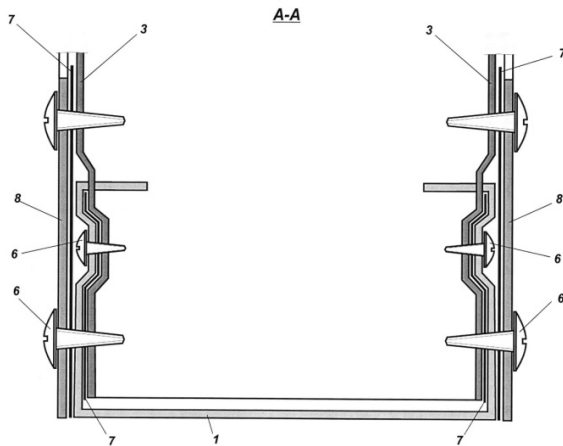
Сечение А-А на рис. 2, соединение внутреннего и наружного соединяемых тонкостенных элементов с усиливающей пластиной и клеящим слое с использованием крепежных элементов в виде саморезов [11], где: 1 - нижний пояс; 3 – стойки; 6 – саморезы; 7 – клеящий слой; 8 – усиливающая пластина.
